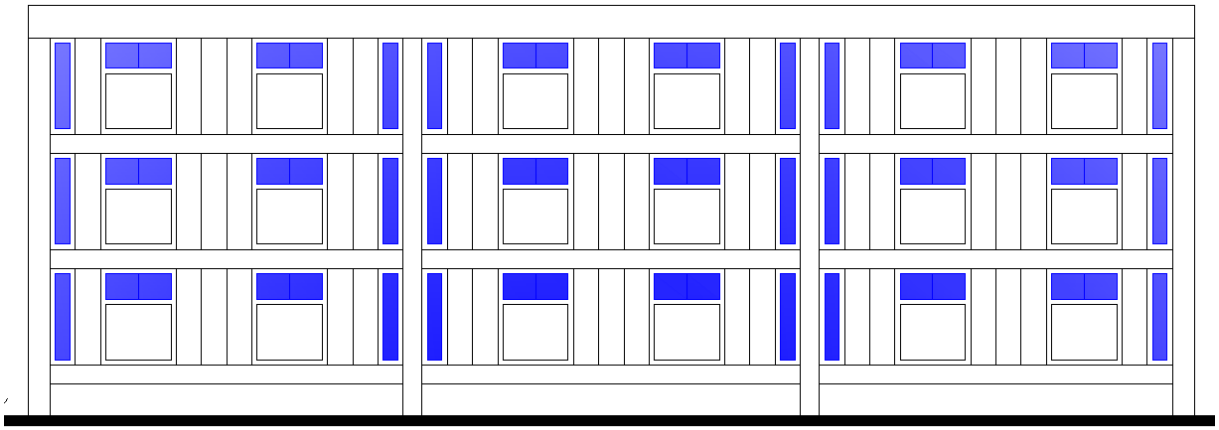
Façade Est (place de la cité les Bananiers) dessinée sur Autodesk-Autocad.
